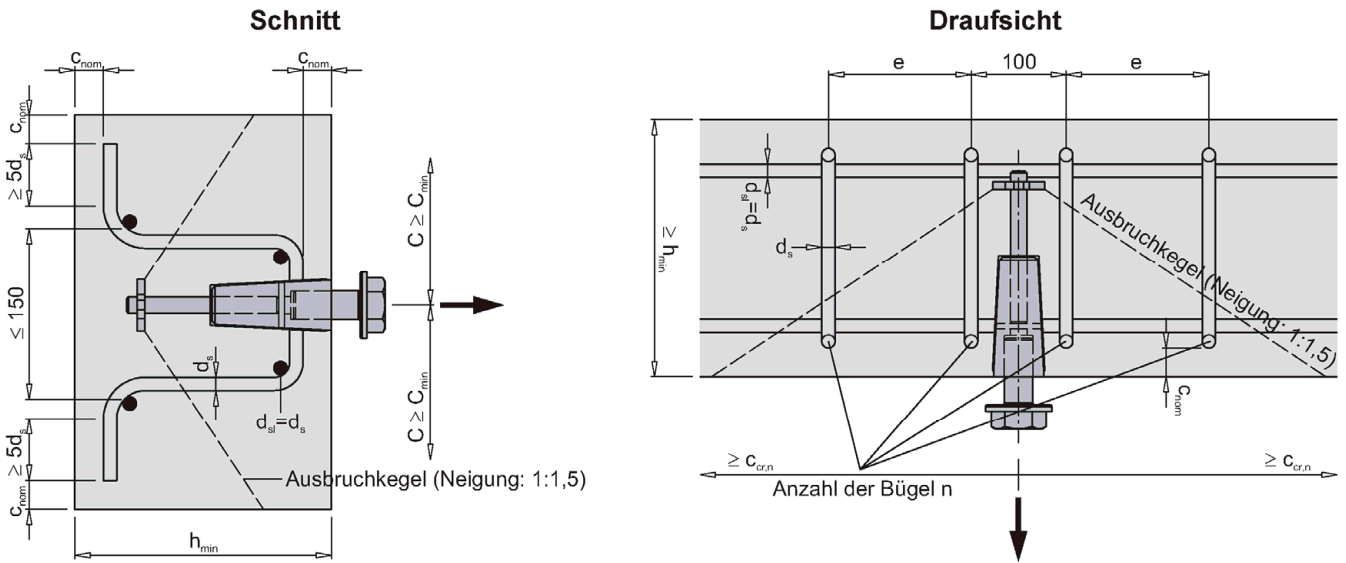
Einbausituation in dünne Wände - Zugbeanspruchung mit Rückhängebewehrung - Bewehrungslage
